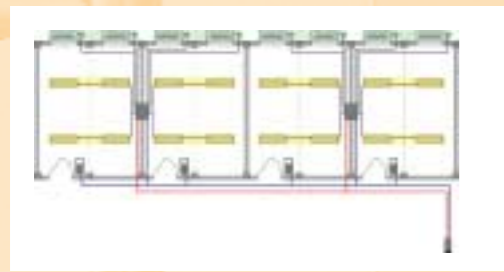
Raumorientierte Installation mit Busbedienung (ursprüngliche Planung)
